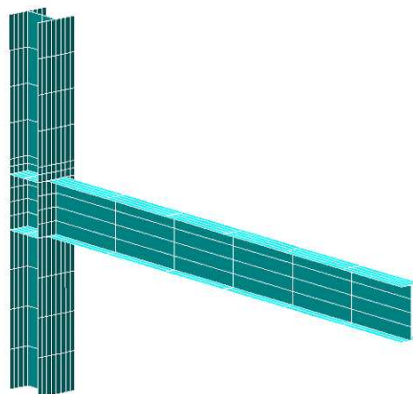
Modelação de uma ligação viga pilar com elementos de volume
